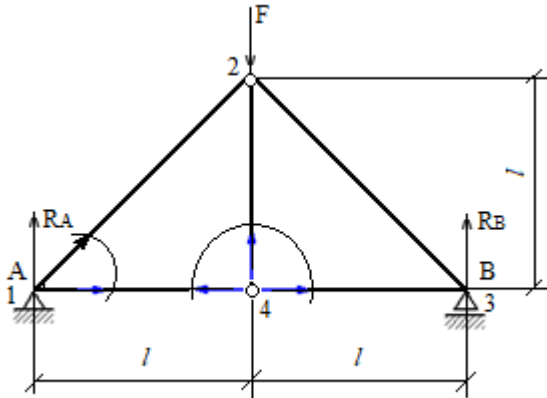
Расчетная схема фермы по определению перемещения узла 4
